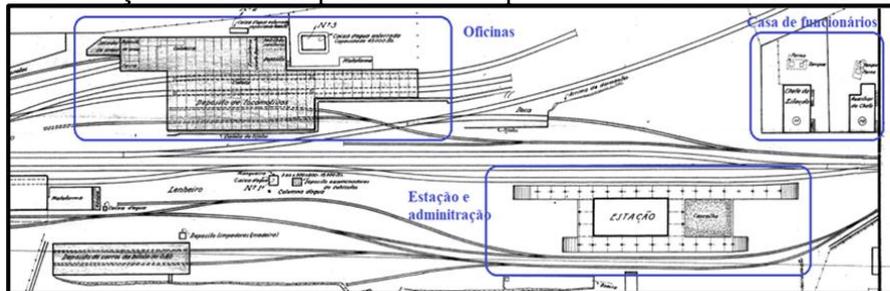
Parte da planta baixa do pátio ferroviário de Porto Ferreira
